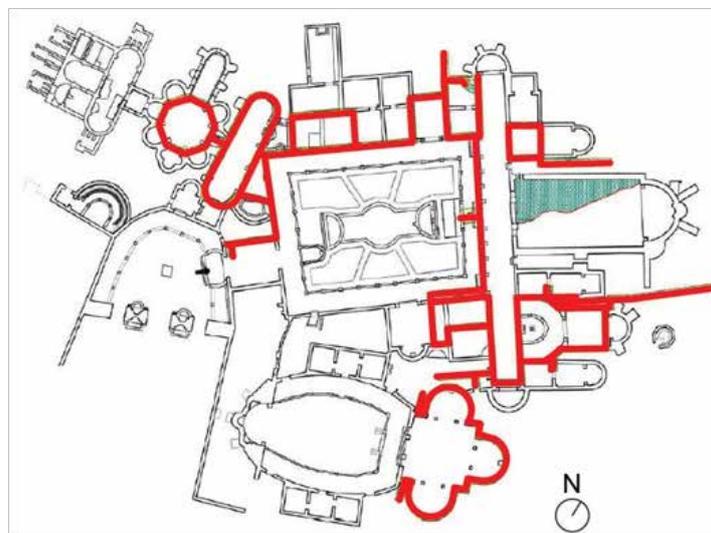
Pianta di Villa del Casale con evidenziazione delle passerelle installate sulle creste delle murature.
